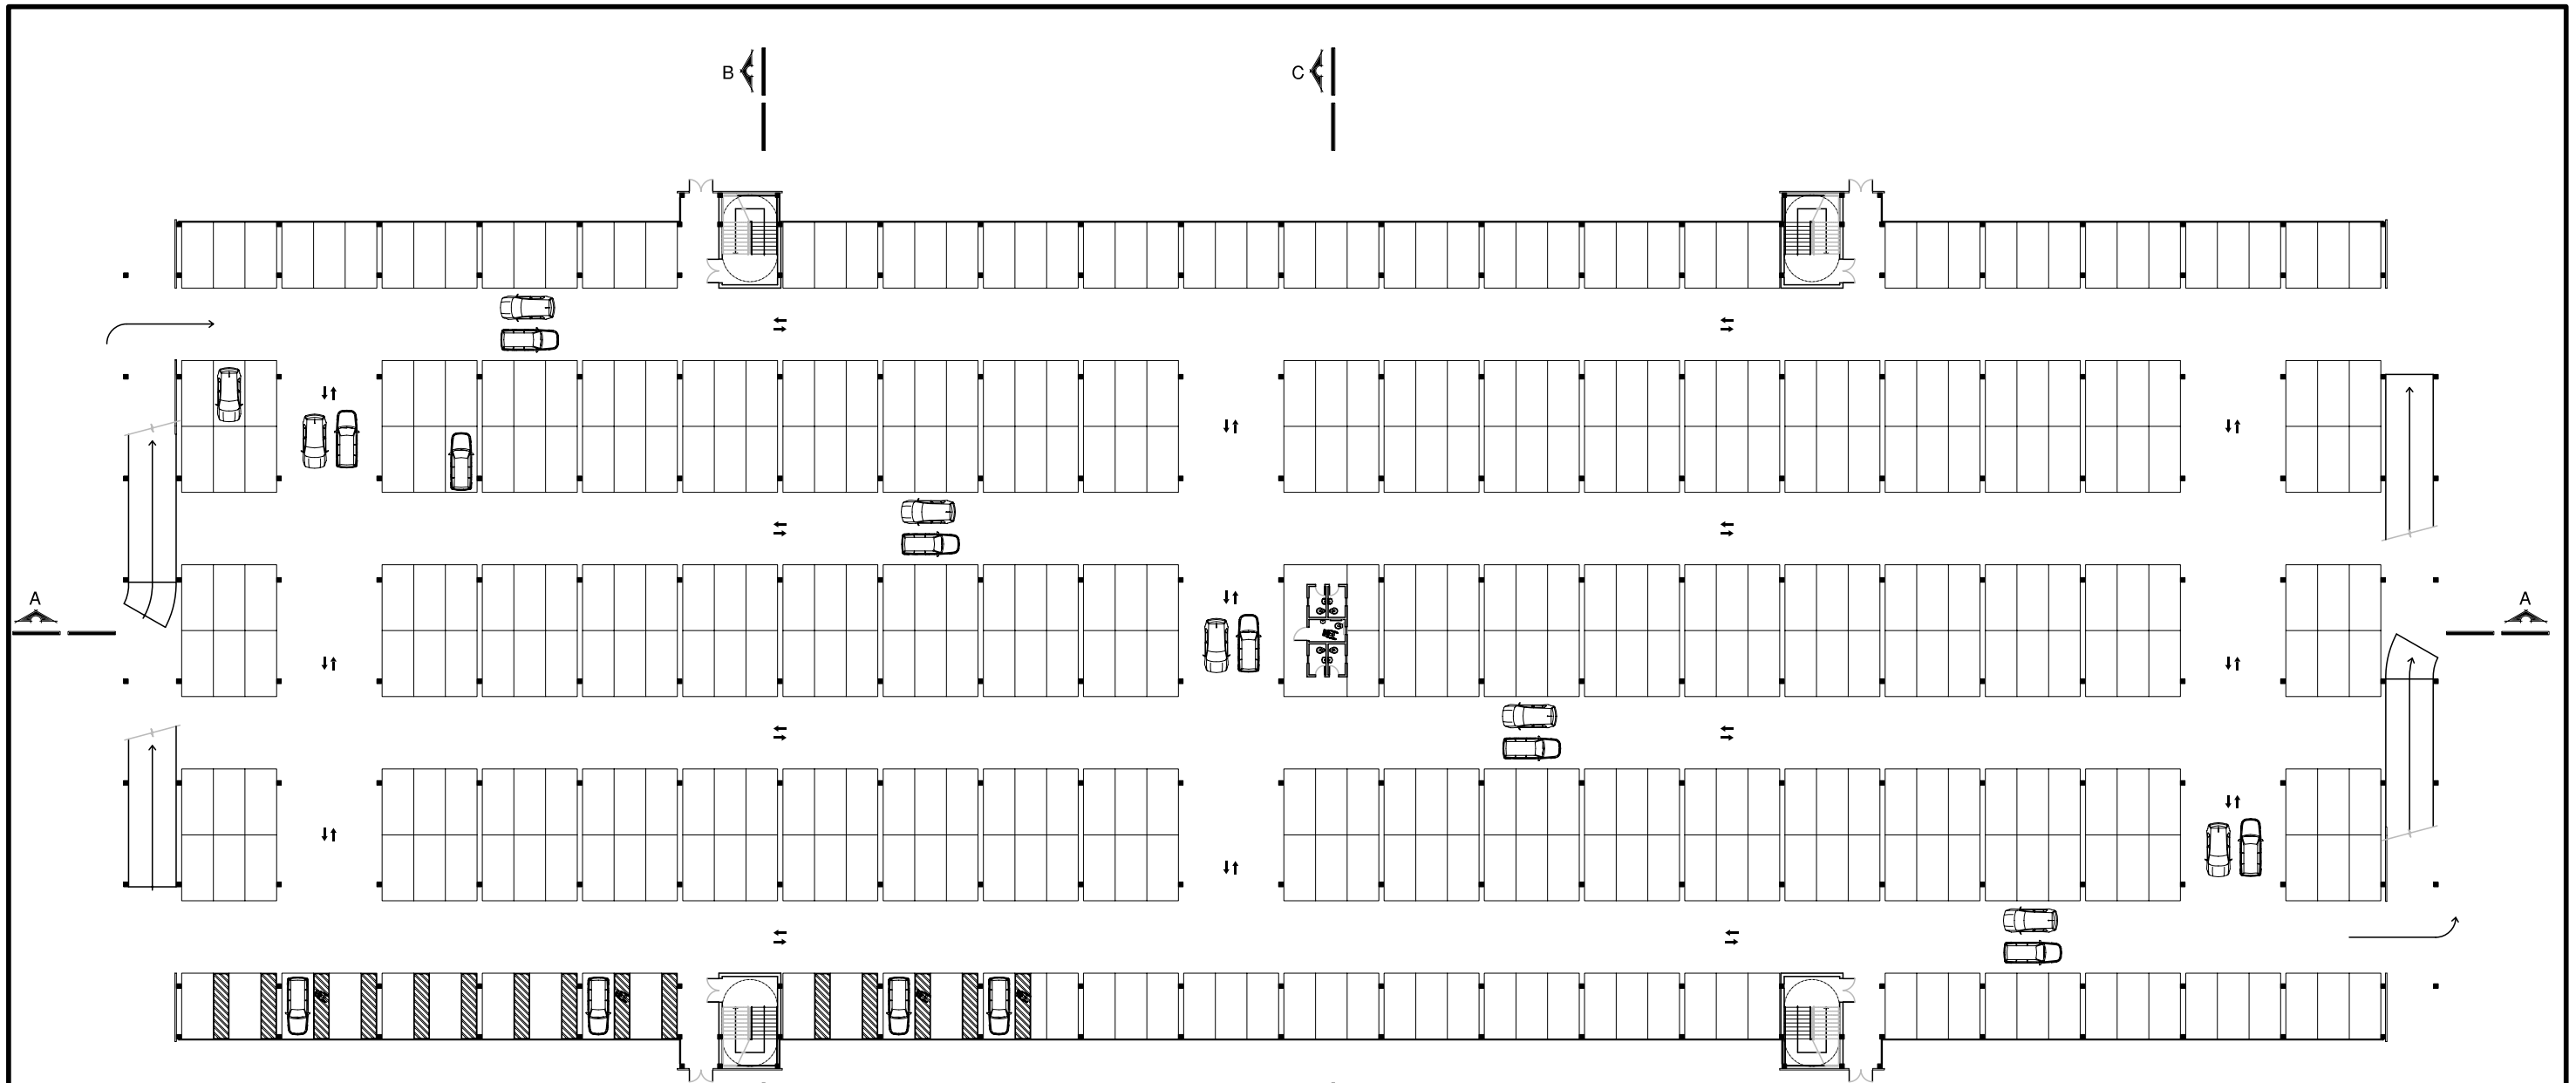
Primeiro Pavimento, (KINDLER, 2004)
